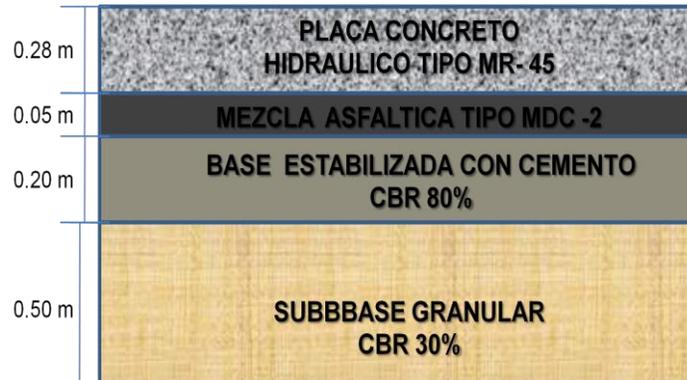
Estructura del pavimento en concreto rígido para la Transversal 54.⁵⁸
